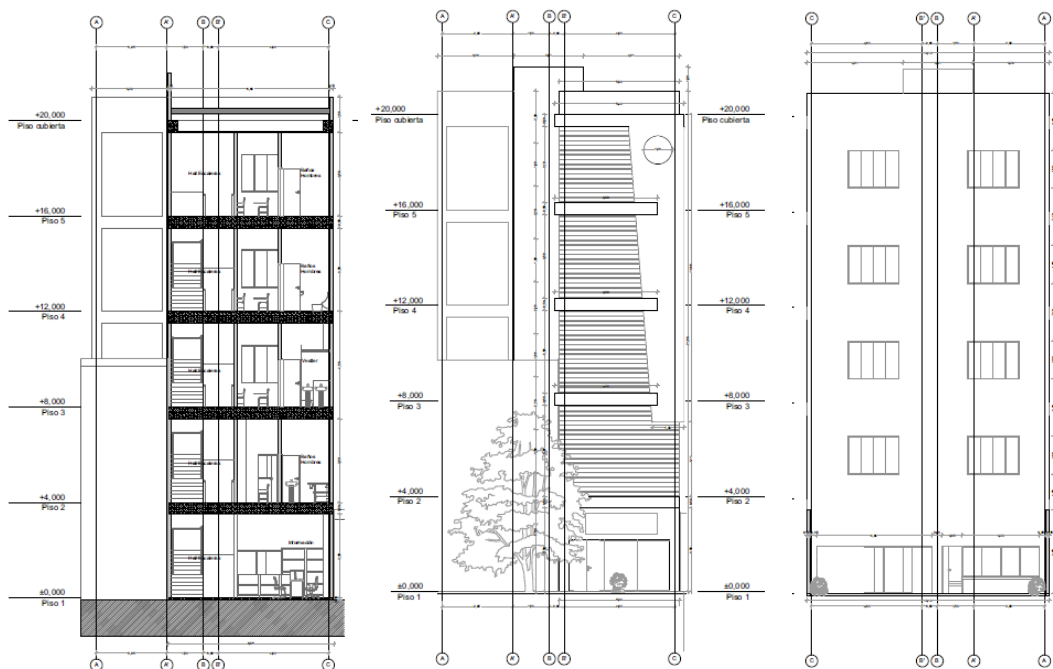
Sección Arquitectónica S-02. Fachadas Frontal y Posterior. Actual Cafaba.
